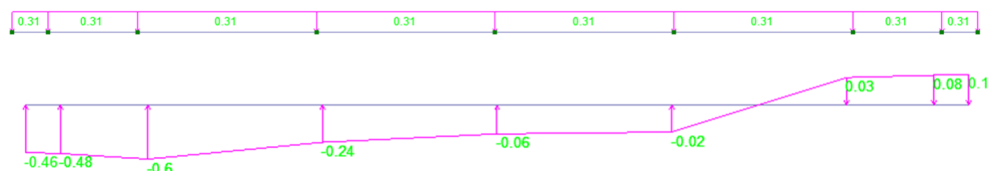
Схема приложения нагрузка на балку: верх – нагрузка от собственного веса кровли, низ – ветровая нагрузка
